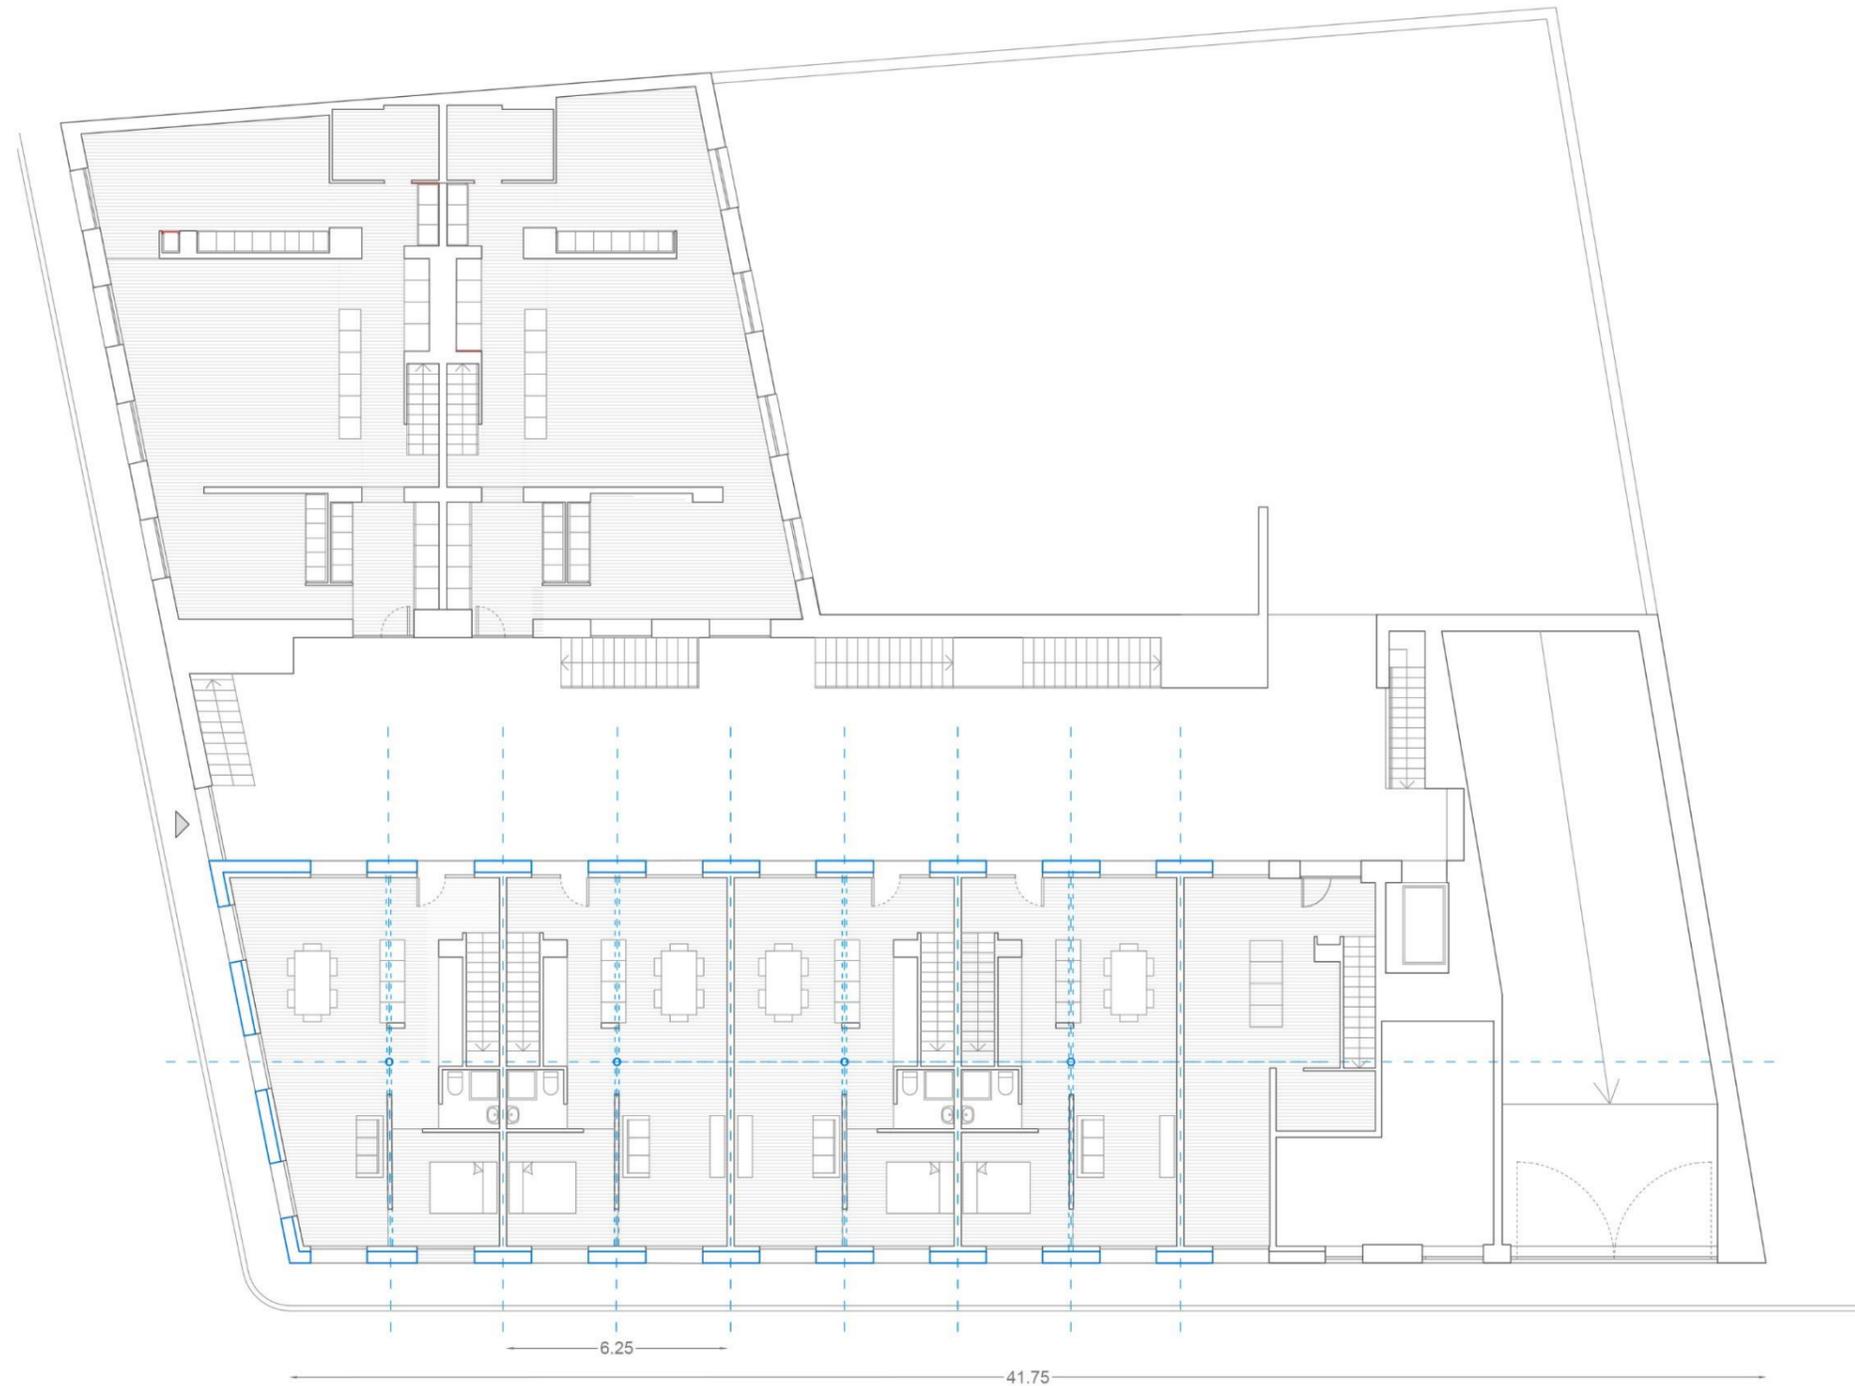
PLANO 1/200. Planta baja intervenció fàbrica Tort Can Planell.
